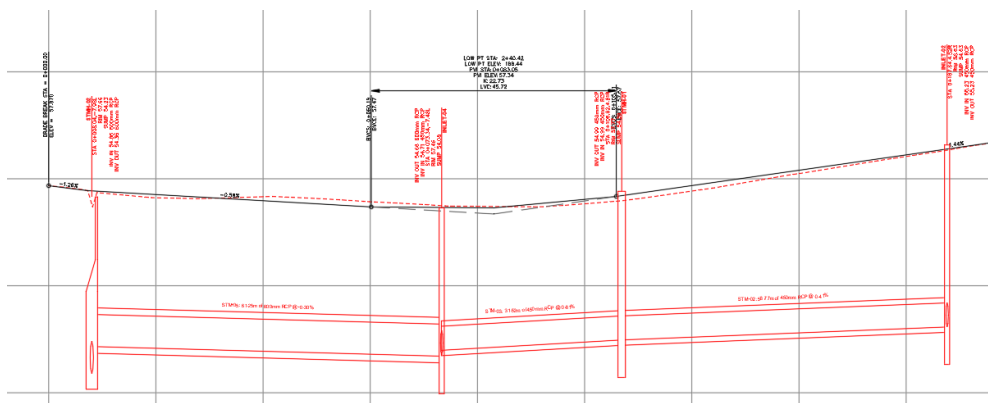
Начальное размещение меток трубопроводной сети на виде профиля
